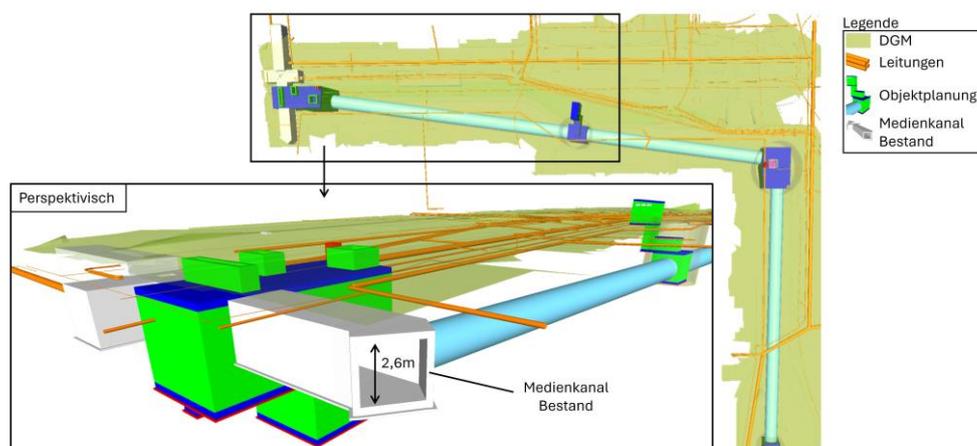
Draufsicht des bestehenden und beplanten Medienkanals mit perspektivischem Detailausschnitt der Fachmodelle IBW, DGM, INF, LAA (Urheberschaft: BlmA)
